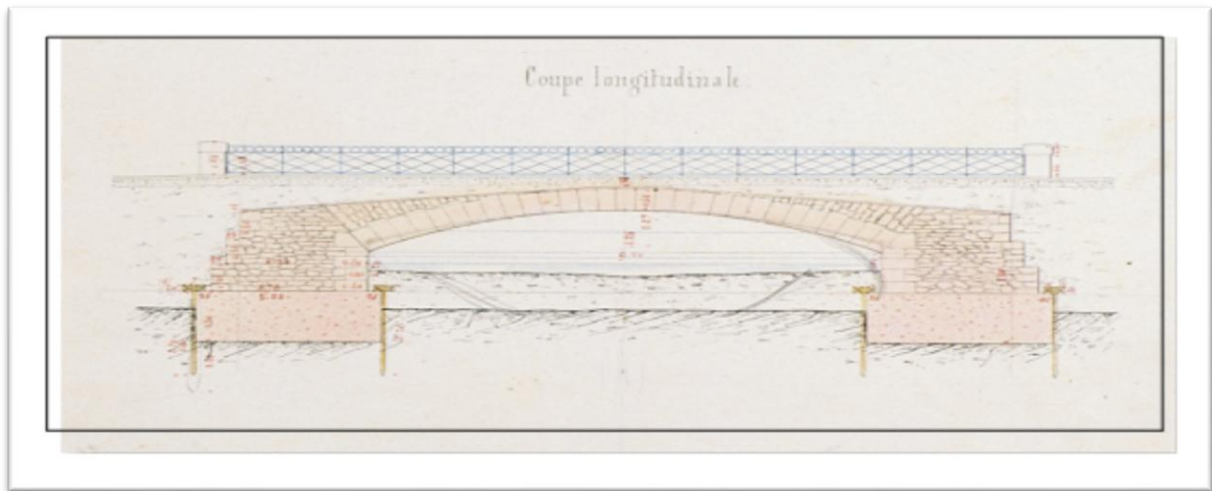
coupe longitudinale d'un pont renforcé par des pieux en bois
